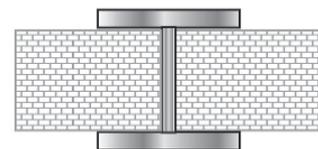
viga de aço com laje de concreto e sobre alvenaria (corte)
